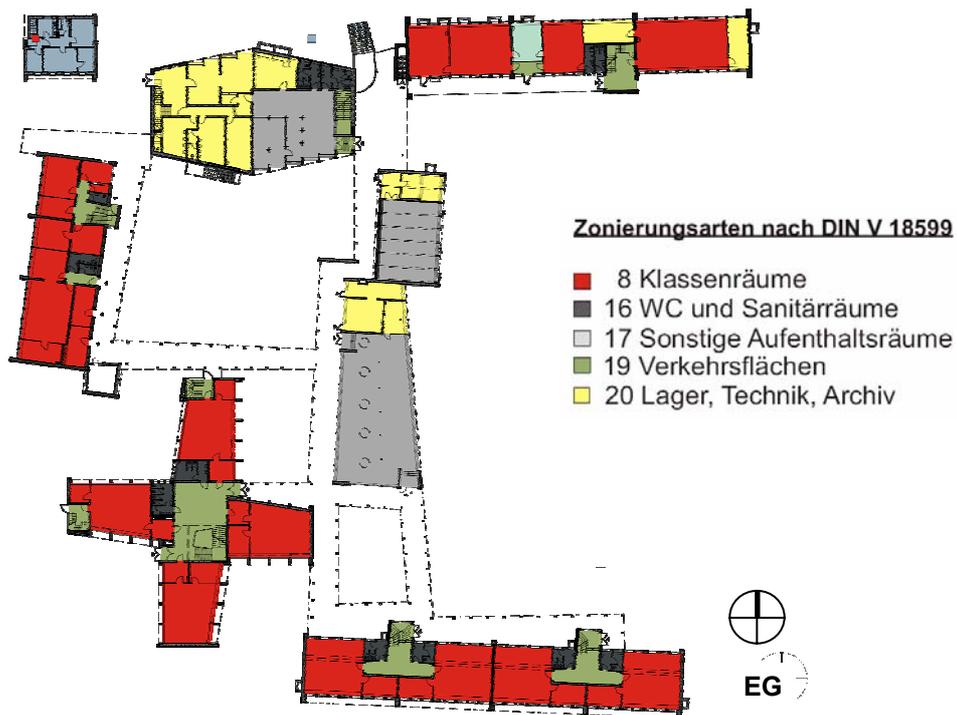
Grundriss EG Grundschule Hamburg
